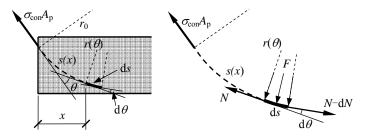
预留孔道中张拉钢筋的拉力和法向压力
